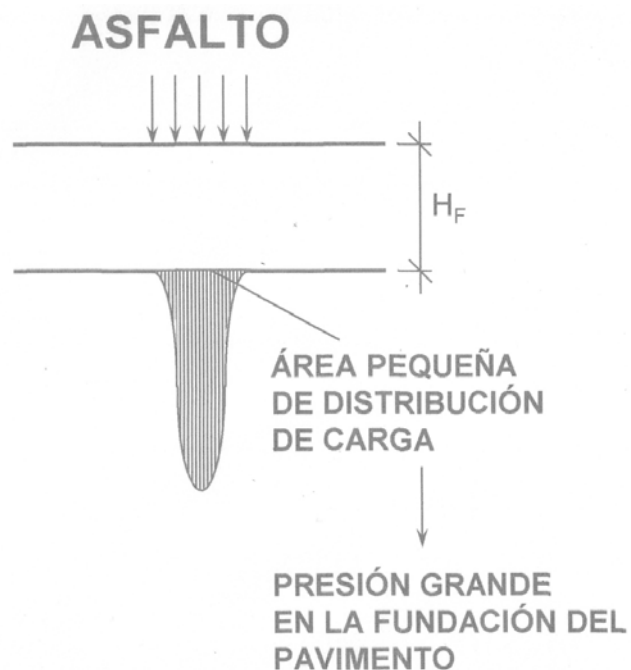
Distribución de Cargas en un Pavimento Asfáltico.
